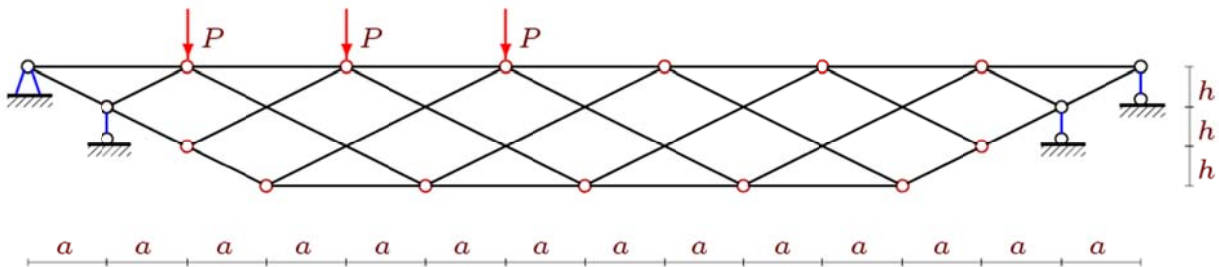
Ферма с нагрузкой по верхнему поясу $n=4$
